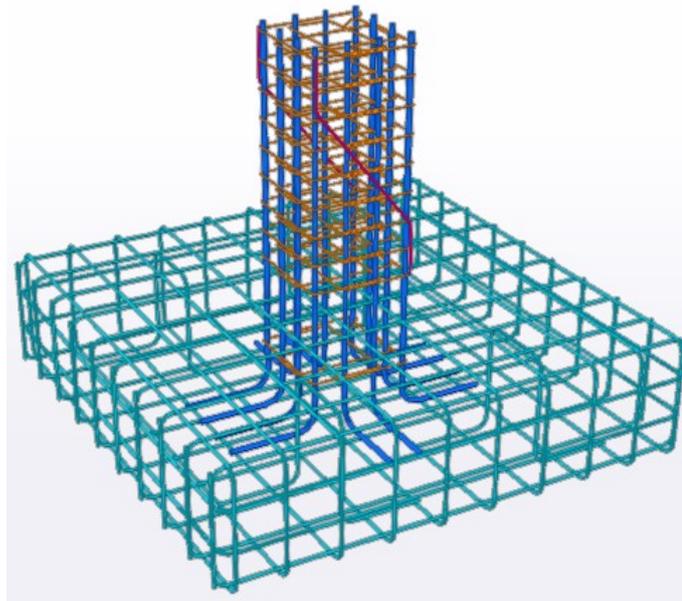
Modelado del acero de refuerzo en zapata - Torre 1.
